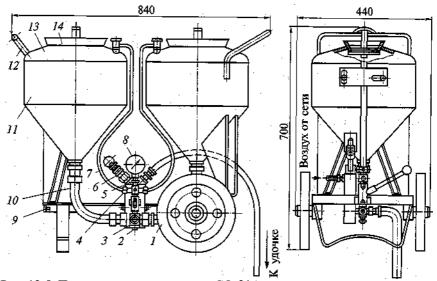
Пневматическая установка CO-21A для нанесения шпатлевки: I — колесо; 2 — кронштейн; 3, 4 — краны; 5 — распределитель; 6 — клапан предохранительный; 7 — воздухоотвод; 8 — манометр; 9 — передвижная рама; 10 шланг; 11 — конусный бачок; 12 — поручни; 13 — крышка съемная; 14 — горловина
